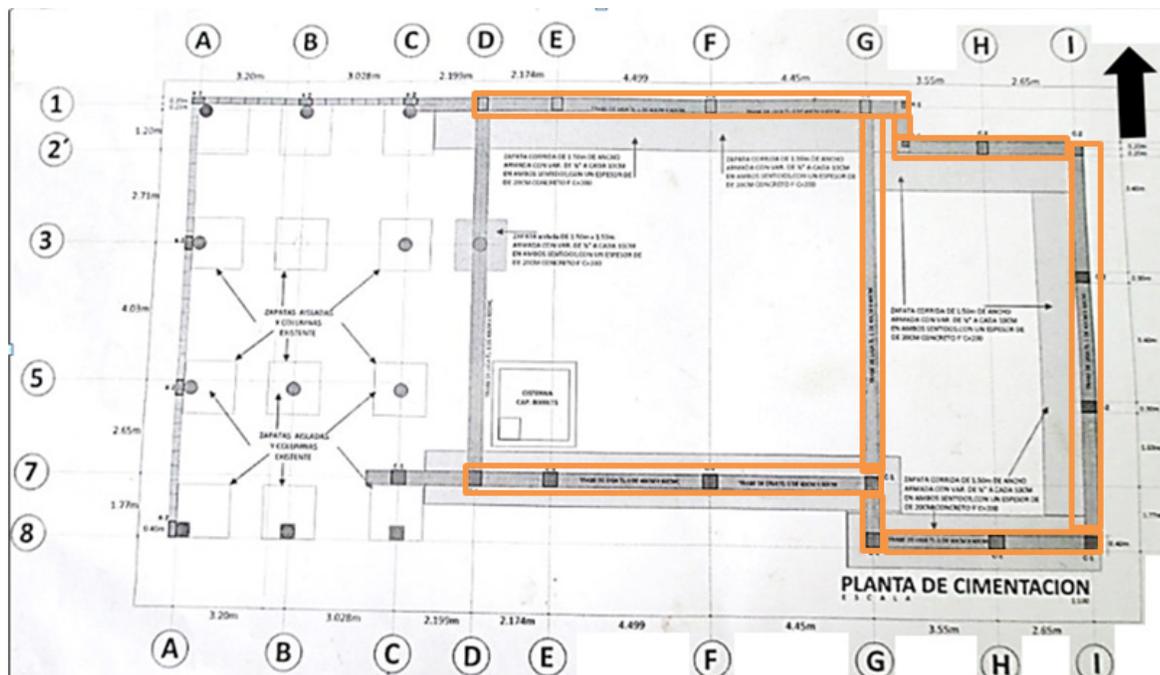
Proyecto de la Planta de cimentación del Predio de la Calle de Miguel Hidalgo No. 107. Se hallan marcadas en color las áreas de excavación de donde se obtuvieron los materiales arqueológicos de este predio. Fuente: Planta de Cimentación Arquitecta "Construcción Sucursal 2 Ignacio Díaz y Macedo IDM".
